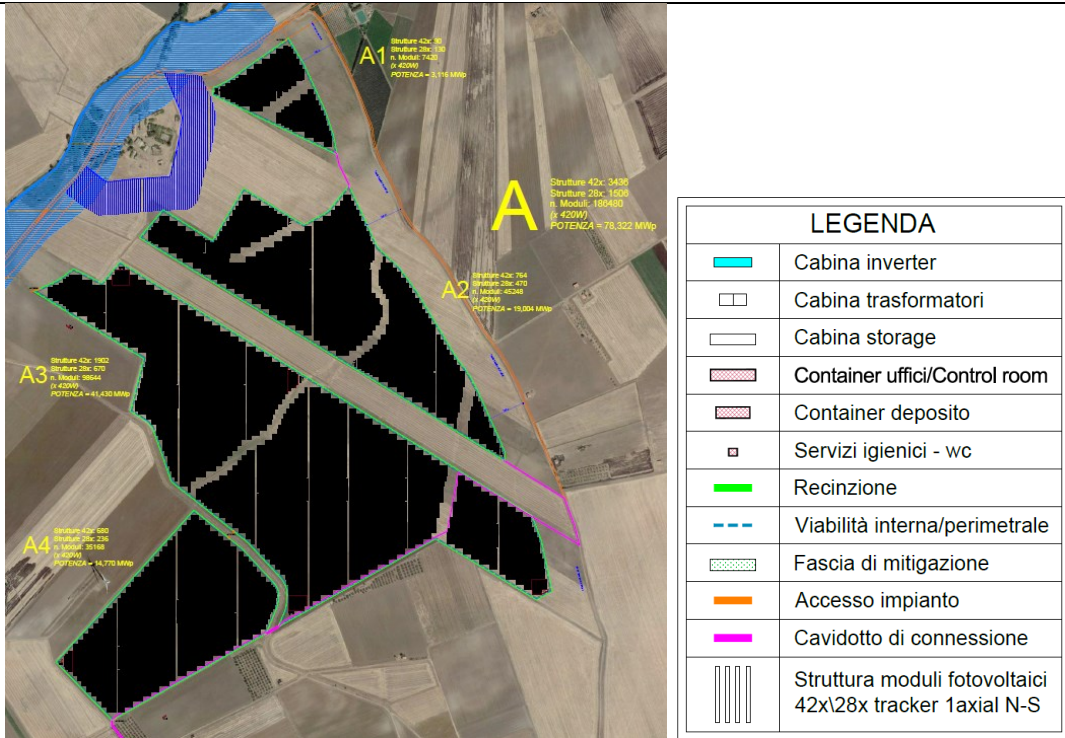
Layout di impianto dell’Area A1-A2 e A3
